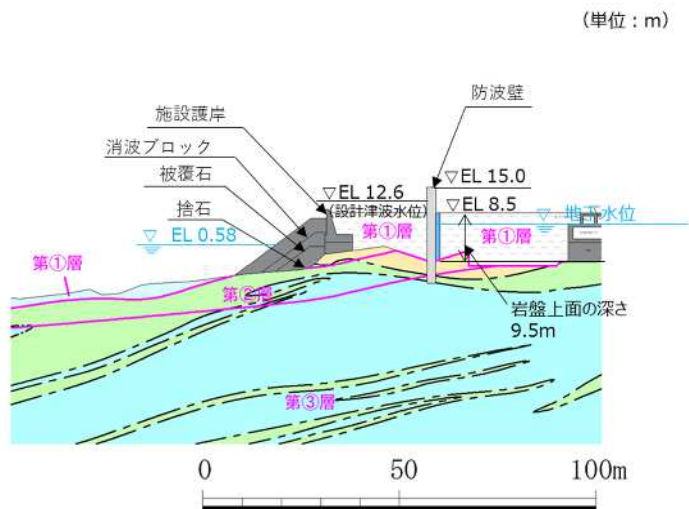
防波壁（多重鋼管杭式擁壁）の横断面図
